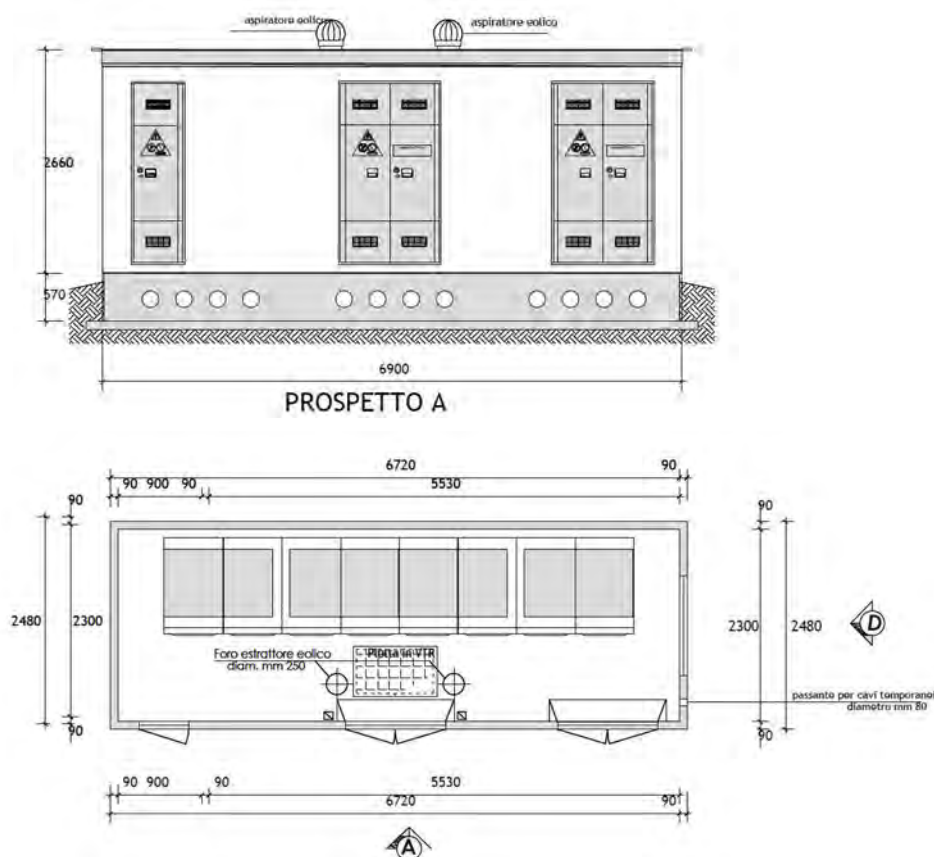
Cabina di sezionamento – Pianta e prospetto
